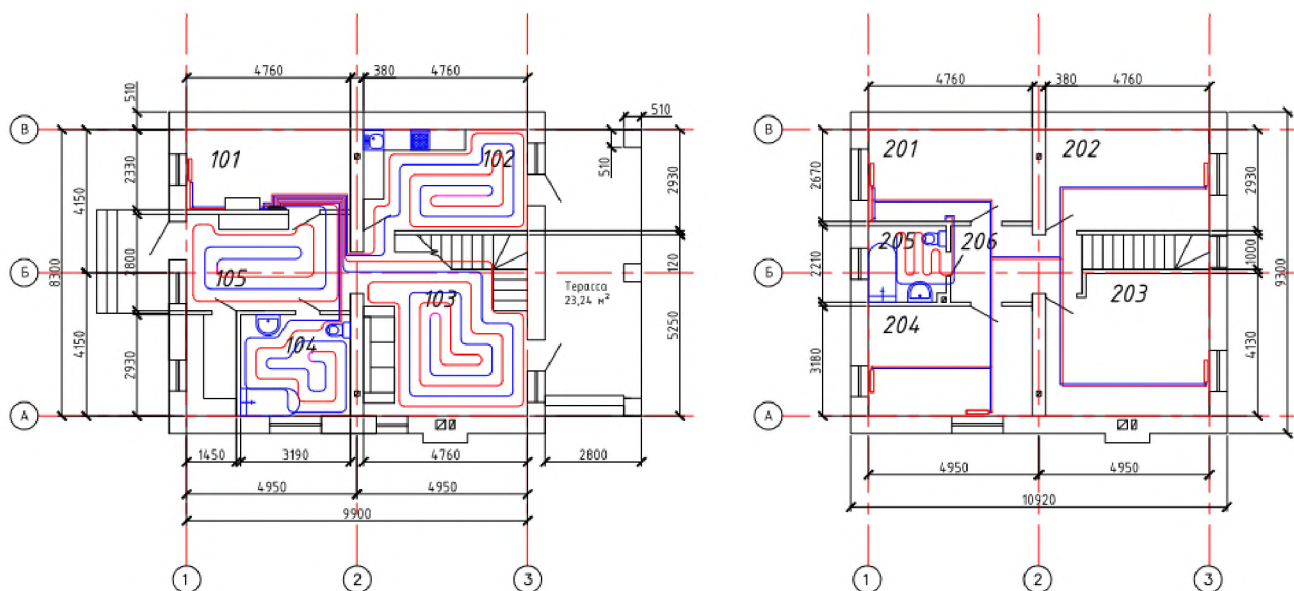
Планы первого и второго этажа с напольным отоплением
